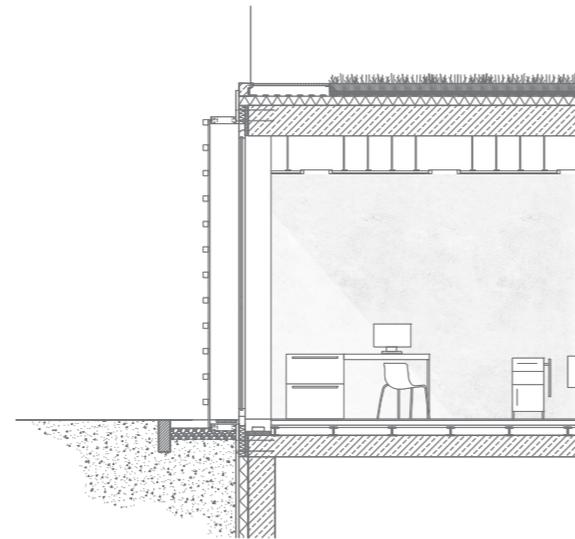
Fassadenschnitt der neuen Pflegestation mit dem Verwaltungsbüro im Erdgeschoss, M.1:100
